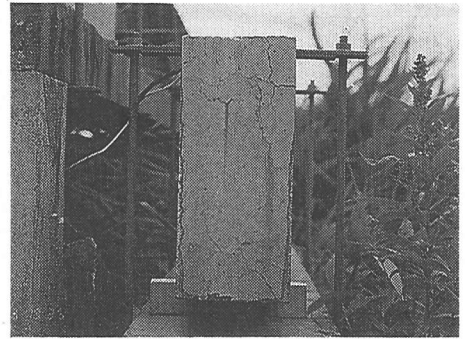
暴露後3年目のひび割れ発生状況 (非電気防食供試体)
